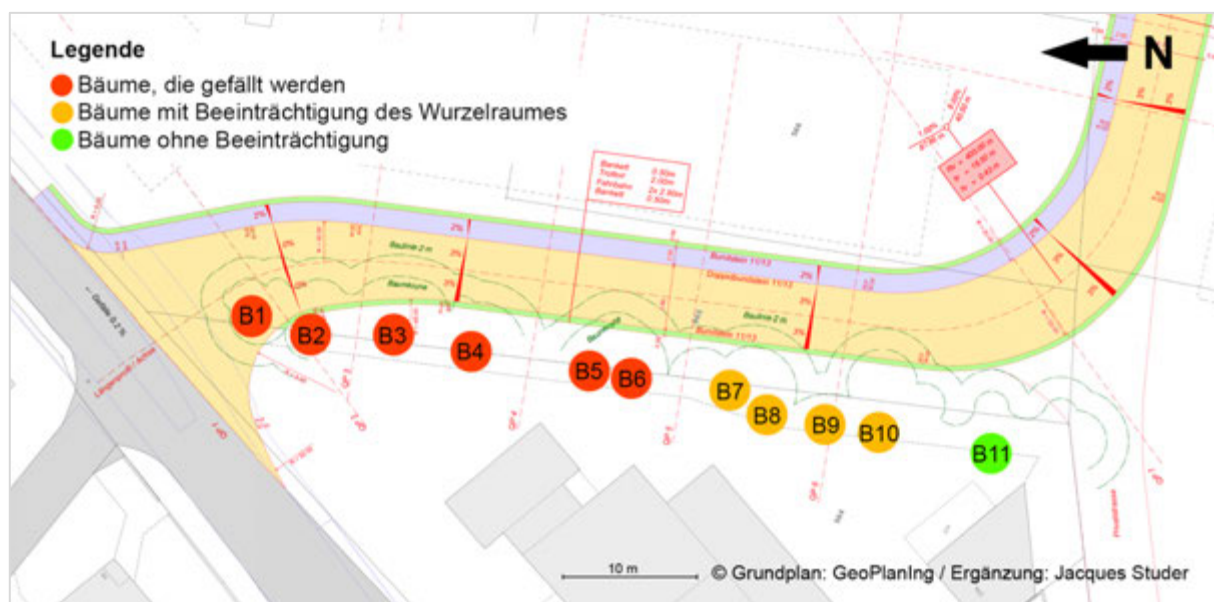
Lage der Baumreihe und der durch den Bau der Strasse beeinträchtigten Bäume.
